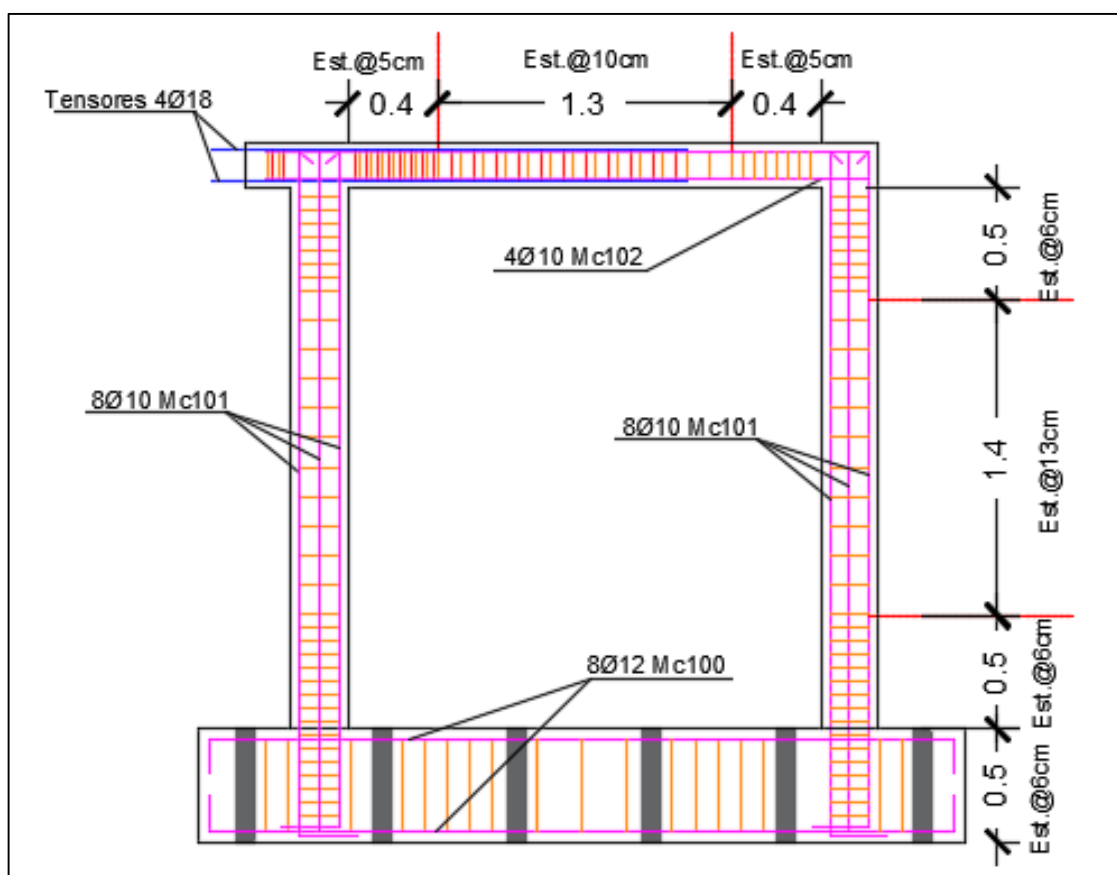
Detalle del armado del pórtico de hormigón, (dimensiones en m)
